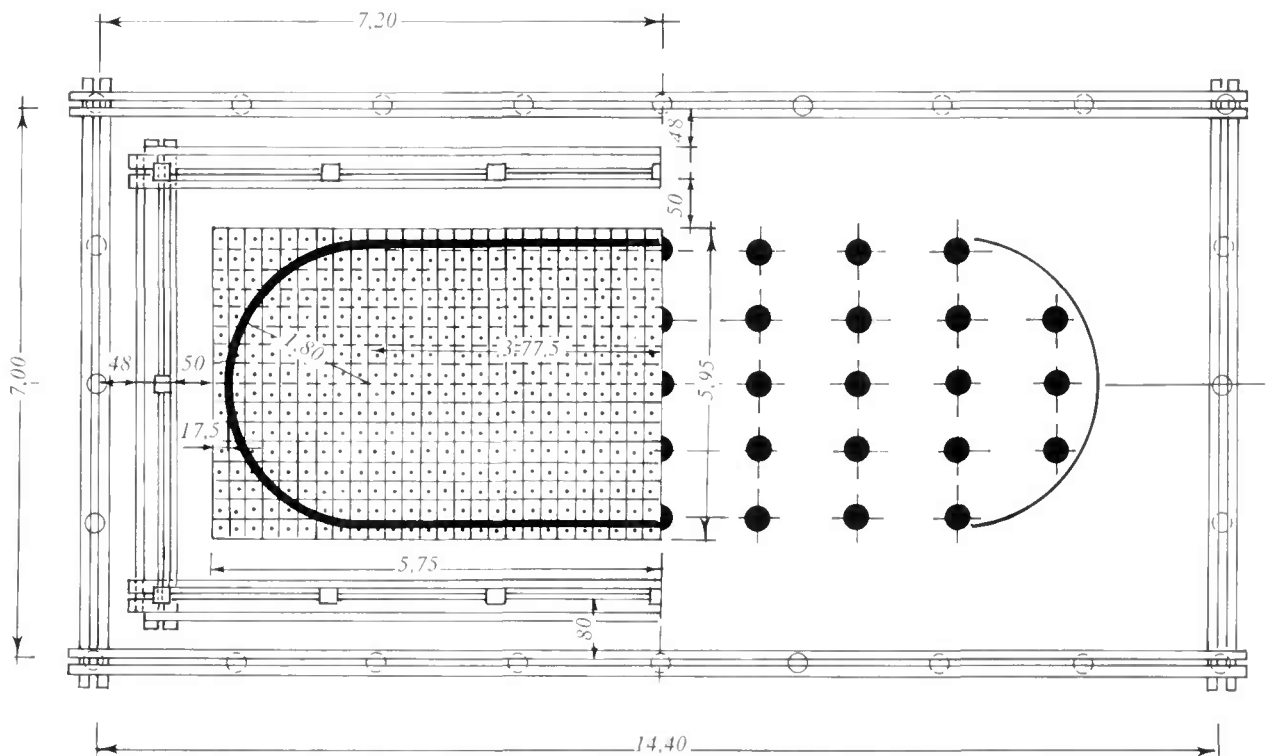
Pont de Thouaré - Plan du caisson et de l'enceinte.
